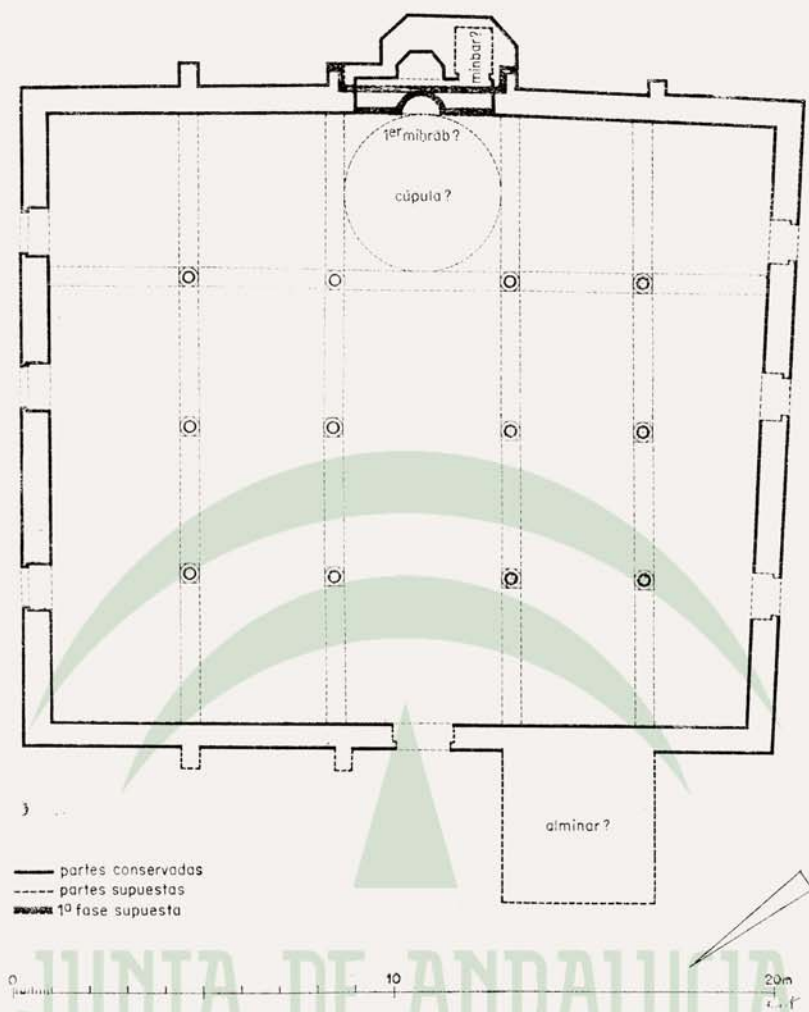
Mértola, mezquita, reconstrucción de la planta (1: 200).
